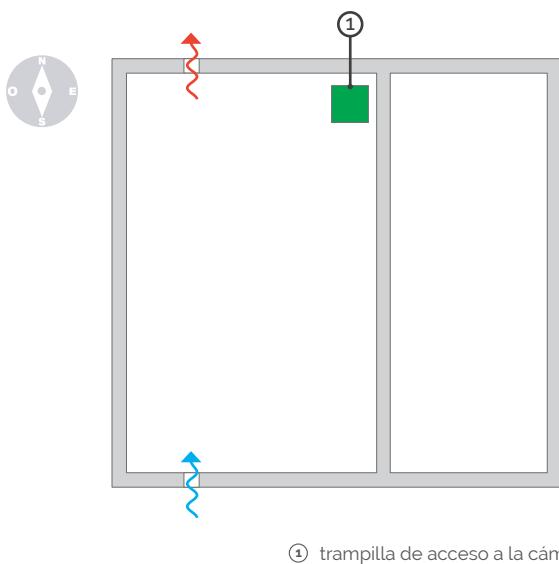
Planta de la cámara sanitaria antes de la intervención con las aberturas de ventilación existentes
